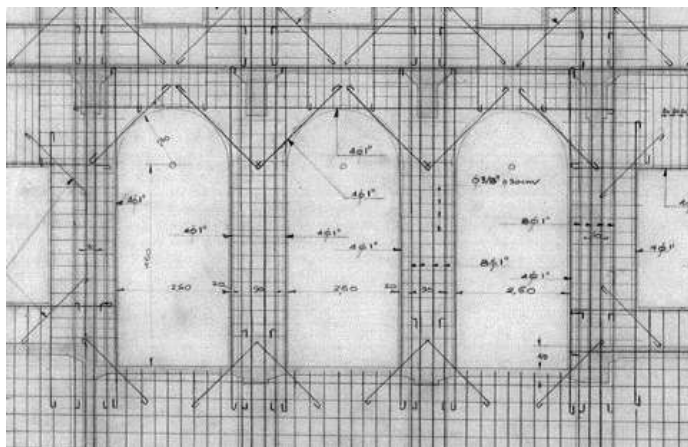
Izq. Detalle elevación fachada principal oriente Plano de cálculo estructural y detalle respectivo. Archivo Digital Ministerio de Obras públicas.
